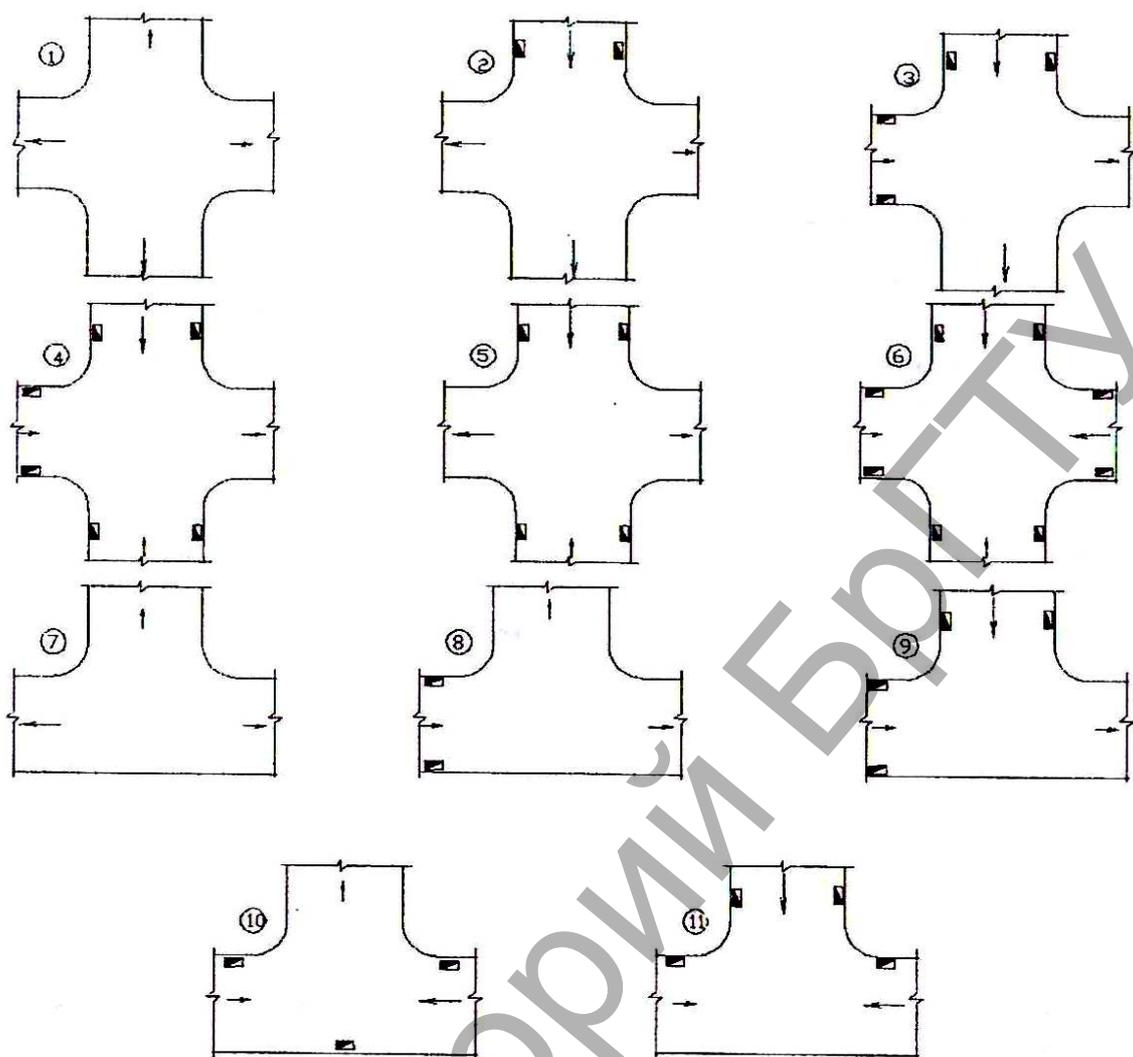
Расположение водоприемных колодцев на перекрестках
